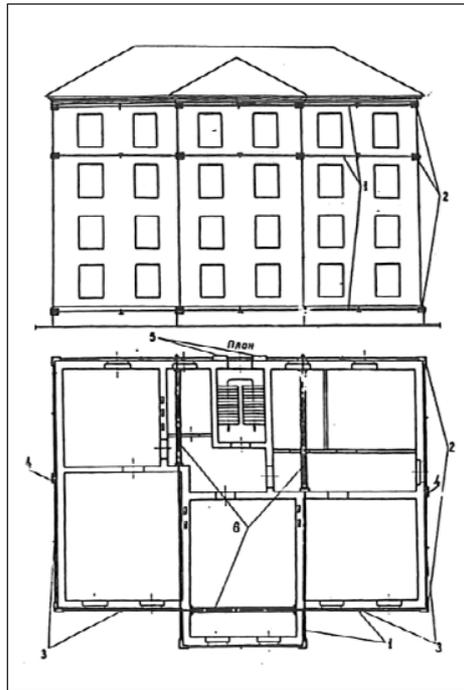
Схема усиления стен здания с помощью одиночных стальных стяжей: а – по фасаду, б – в плане; 1 – стальной тязь, 2 – угловой обжимной элемент, 3 – промежуточный обжимной элемент, 4 – связь-распорка, 5 – переходная вставка в месте разрезки тязя дверным проемом
